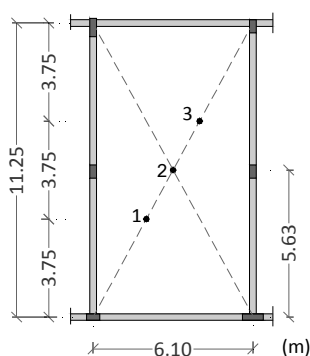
Características da laje ensaiada e representação dos pontos de medição
